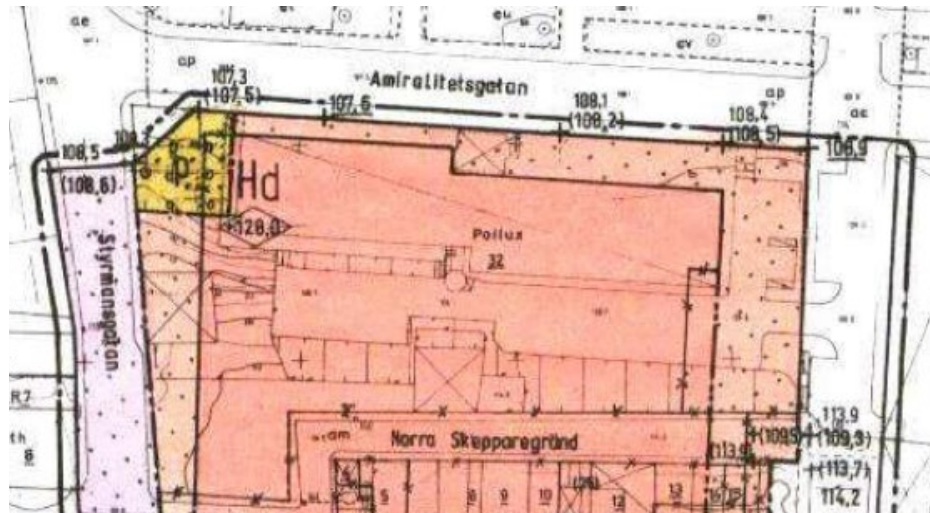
Utsnitt ur gällande detaljplan, Dp 392, som omfattar norra delen av planområdet.
